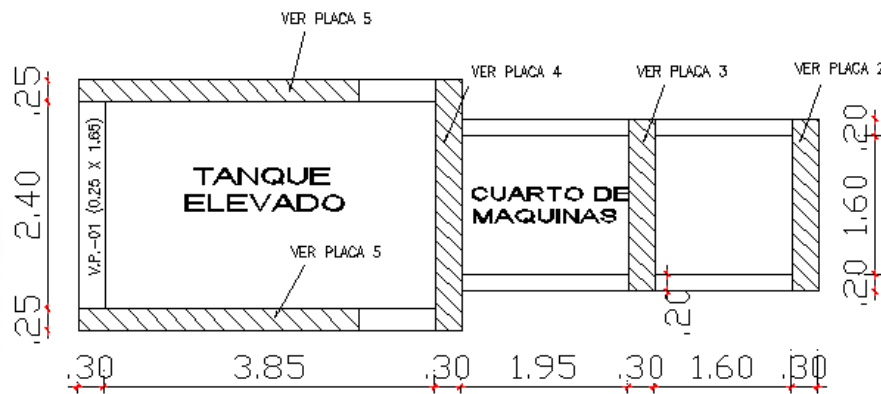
Planta del fondo del Cuarto de Maquinas y Tanque Elevado
